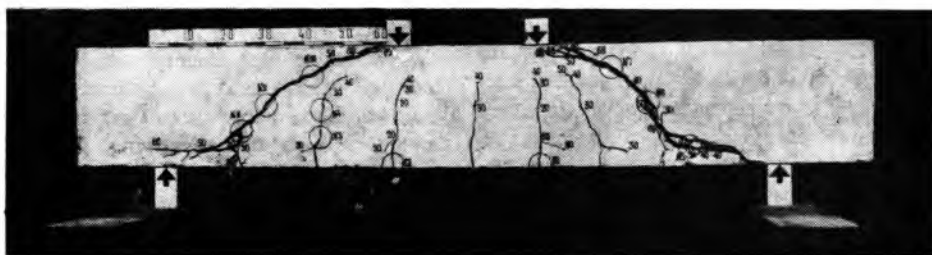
Схемы развития наклонных трещин и разрушение в ненапряженных железобетонных элементах
